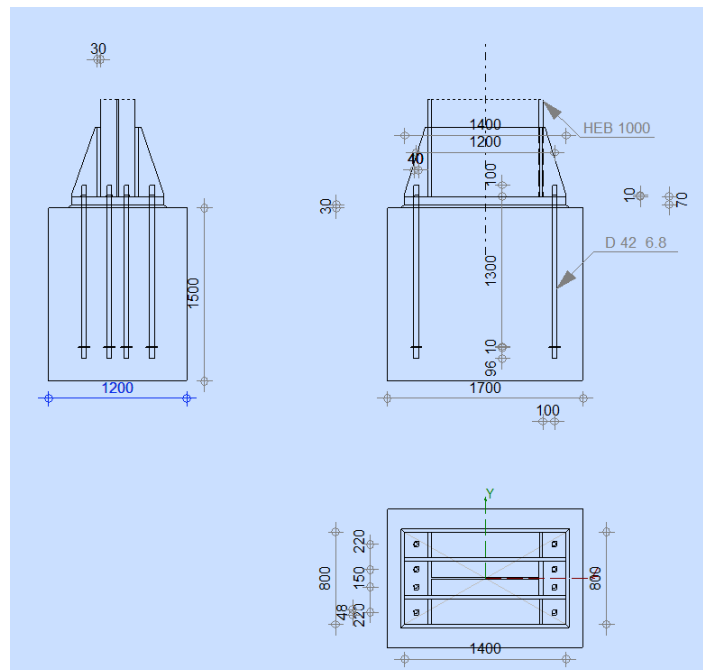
disposition constructive de l'assemblage pied de poteau
